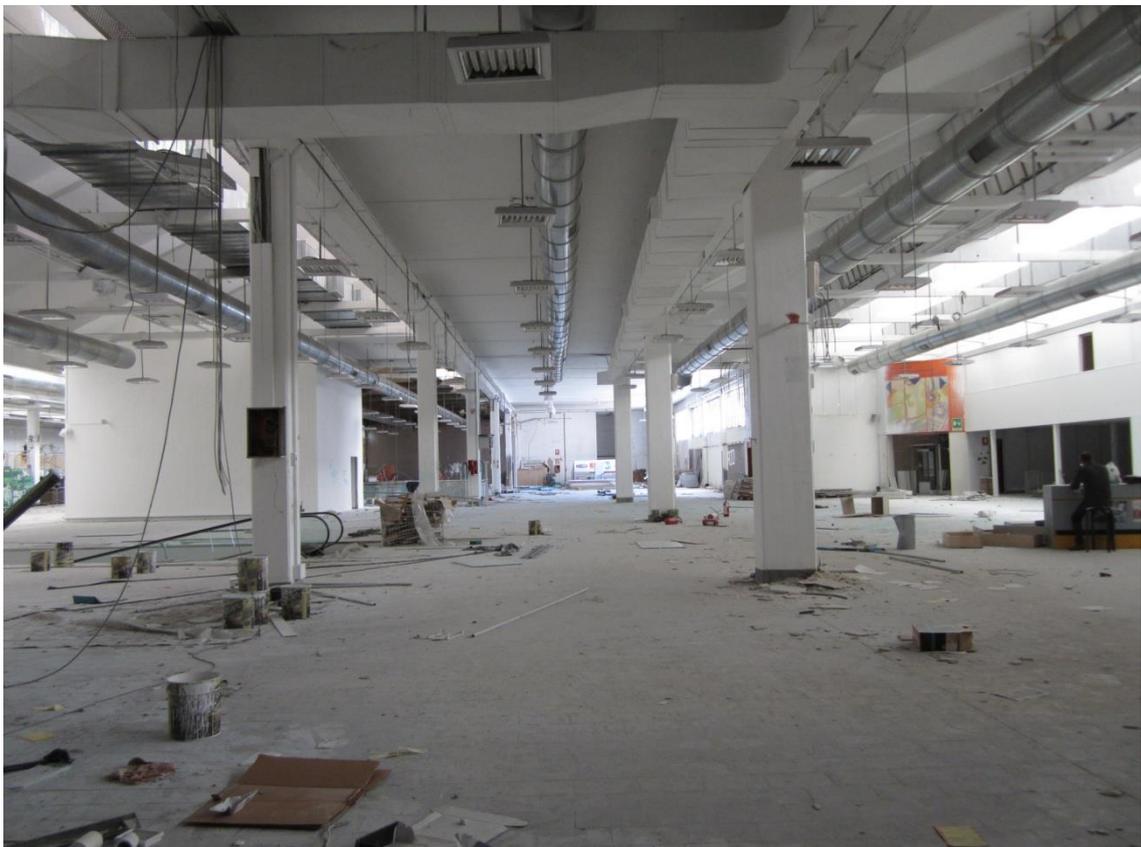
altra inquadratura dell'area pilastrata, destinata alla vendita
